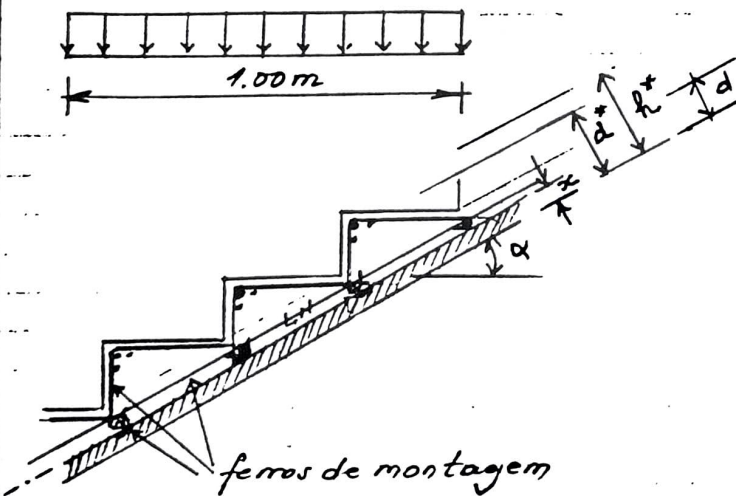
Consideração da colaboração do degrau em escadas armadas transversalmente (armadura no apoio)
